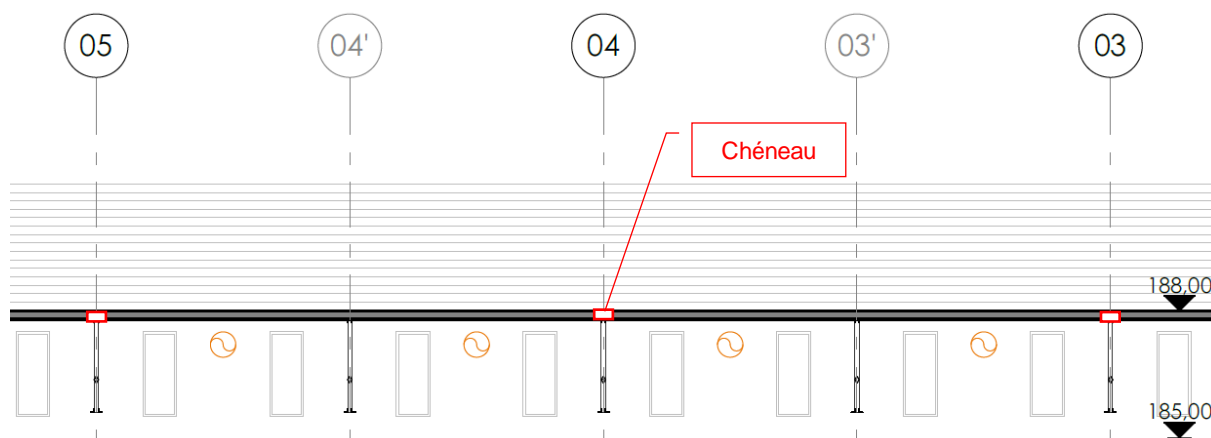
Croquis de la disposition des chéneaux sur la zone centrale de la toiture
